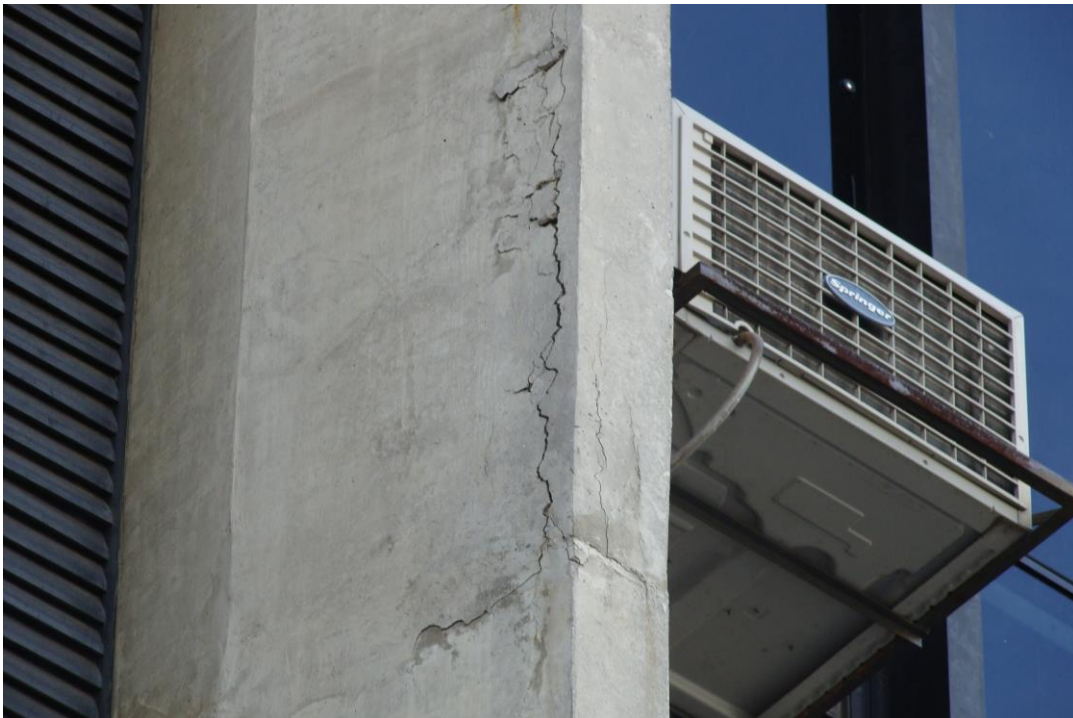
Armadura exposta pilar P13 (2º pavimento) (19/11/2013)
